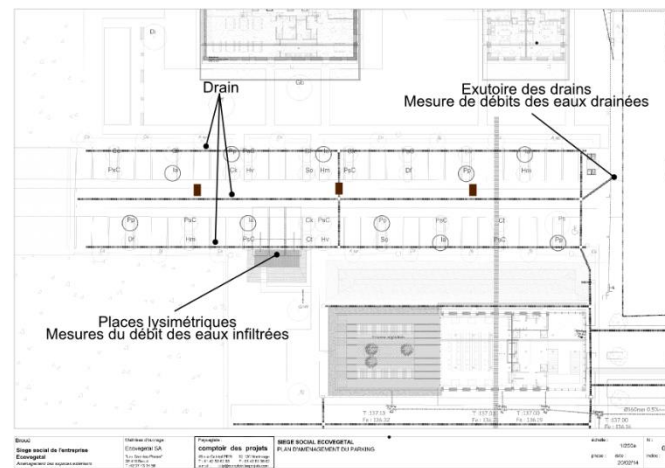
Plan d'aménagement et d'instrumentation du parking perméable de Broué
